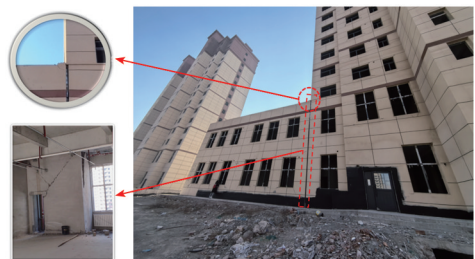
大河家镇某钢筋混凝土剪力墙结构与附属结构碰撞
